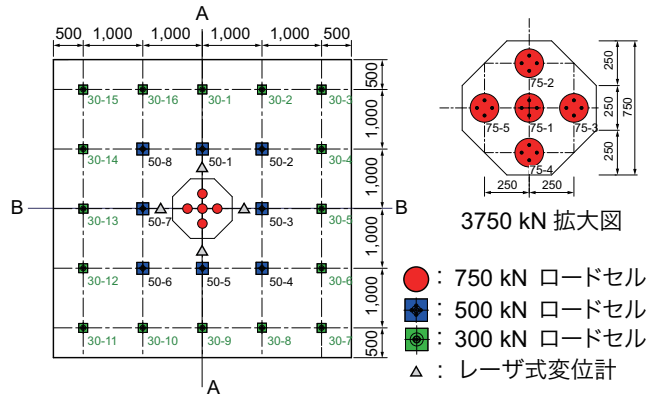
伝達衝撃力計測用ロードセル配置図 (平面図)
